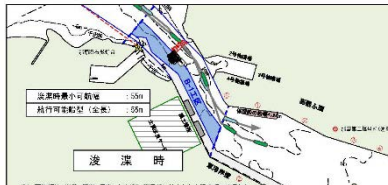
B-1 工区の施工範囲（潜水探査作業および浚渫共通）
